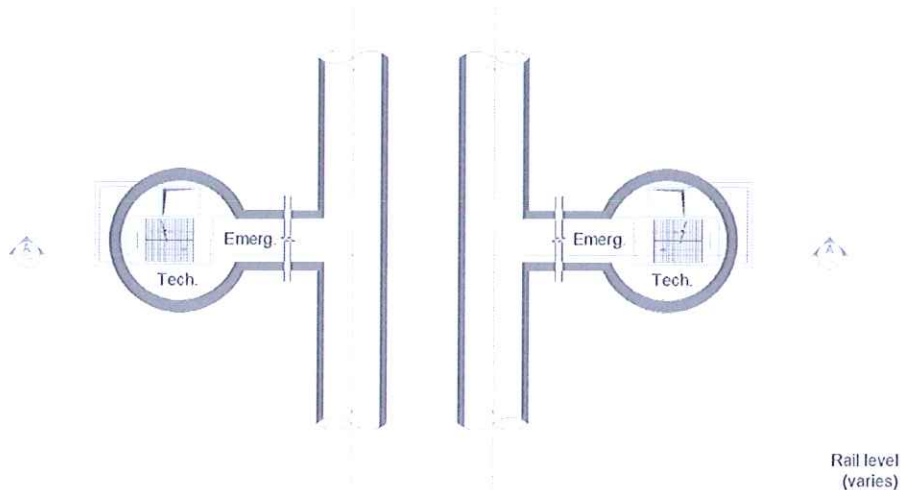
Vedere în plan pentru evacuare de urgență
